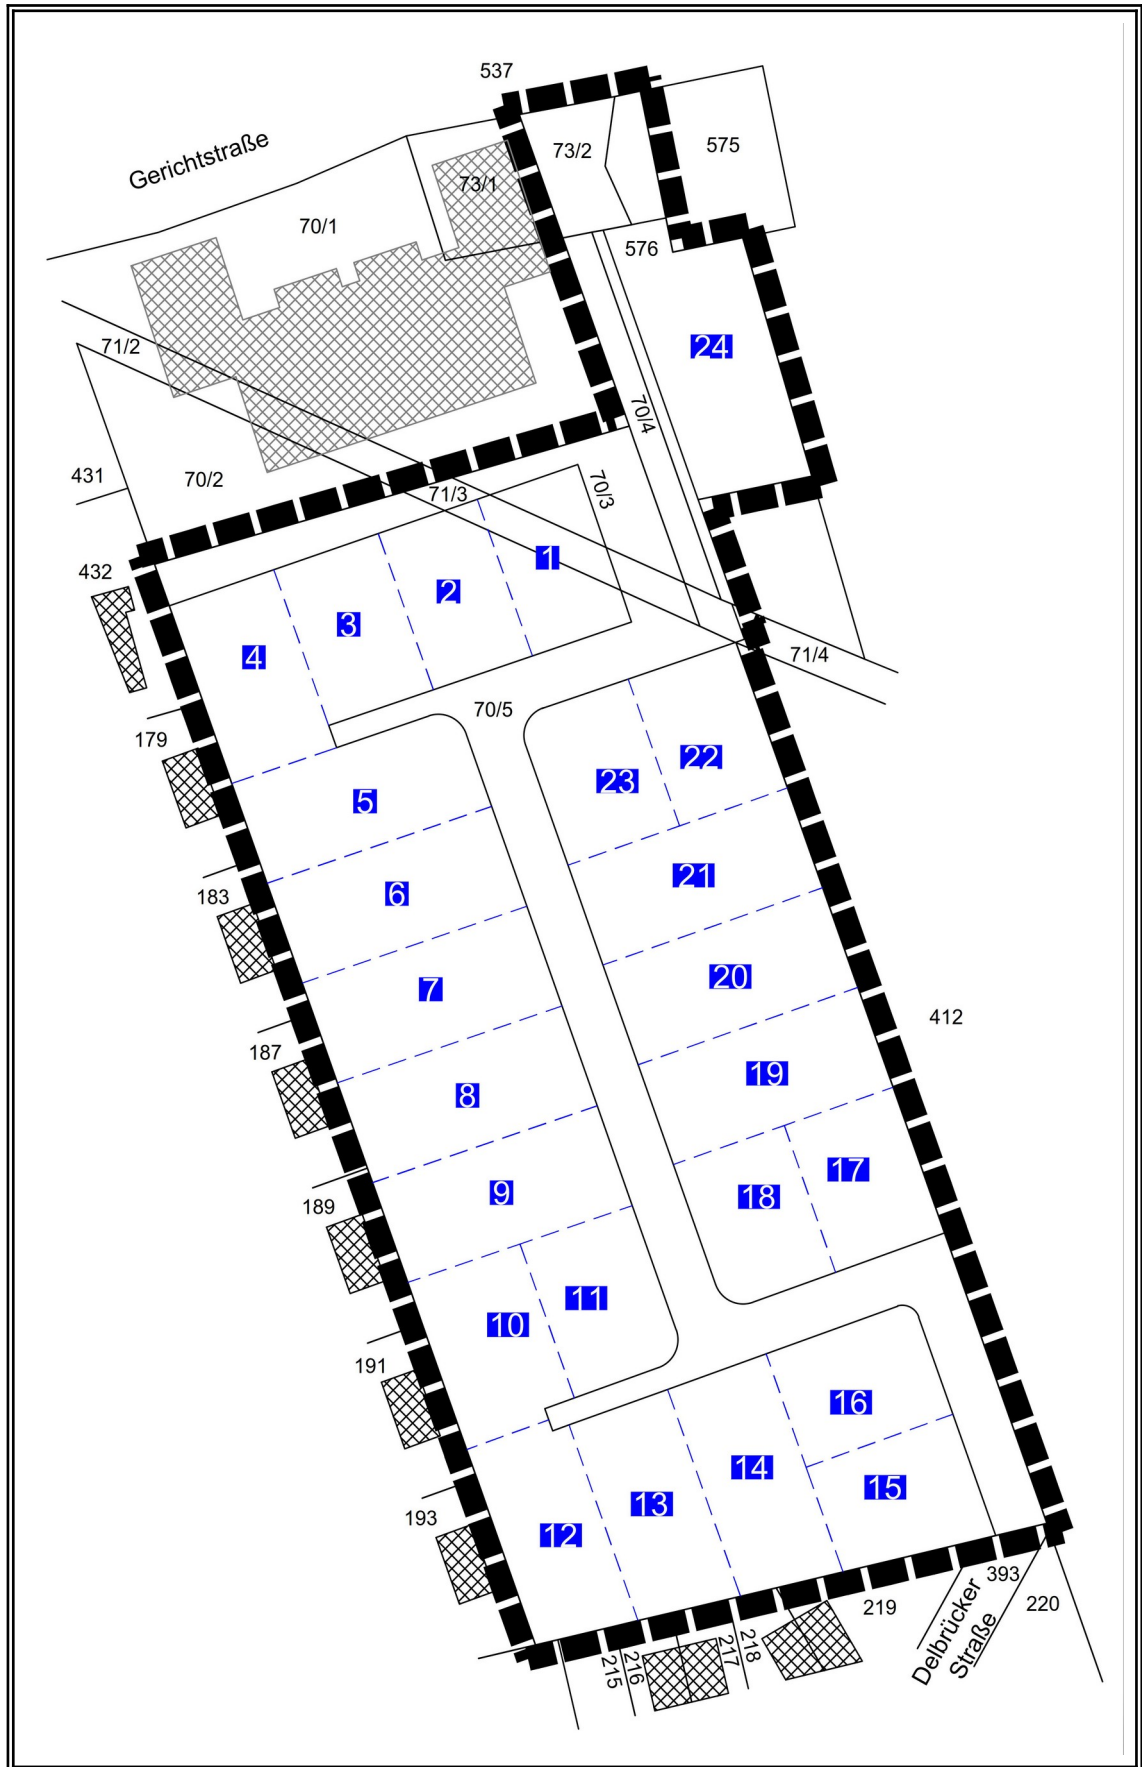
Lage und Nummerierung möglicher Baugrundstücke
